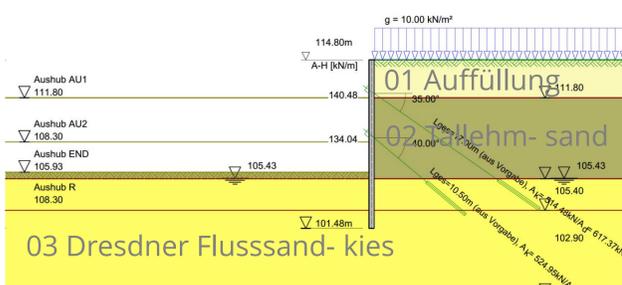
Darstellung der Baugrundsichtung mit einfach rückverankerter Trägerbohlwand des Schnittes 5-5
